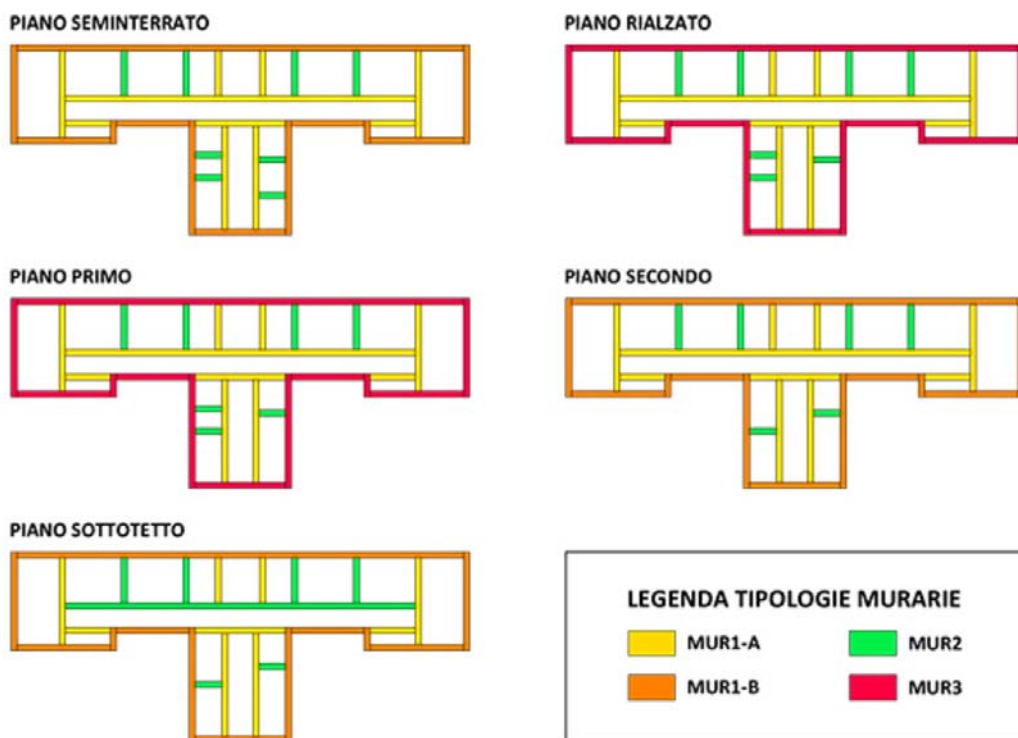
Schema in pianta delle diverse tipologie murarie in ogni livello dell'edificio
